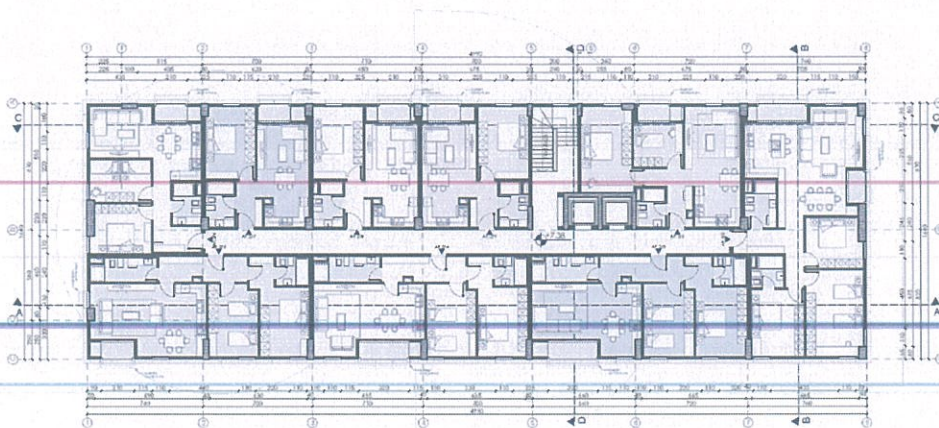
Planimetria e katit të dytë në kuotën +7.38
